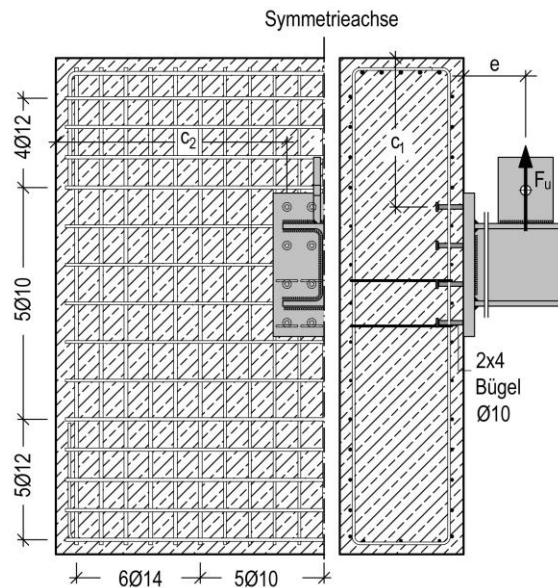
Schematischer Bewehrungsplan des Versuchskörpers R2-1Q
